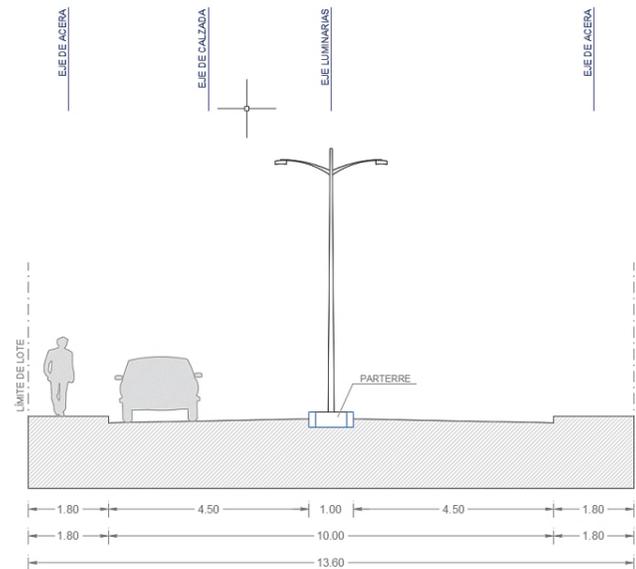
Sección transversal calle de nueva apertura al interior del proyecto
